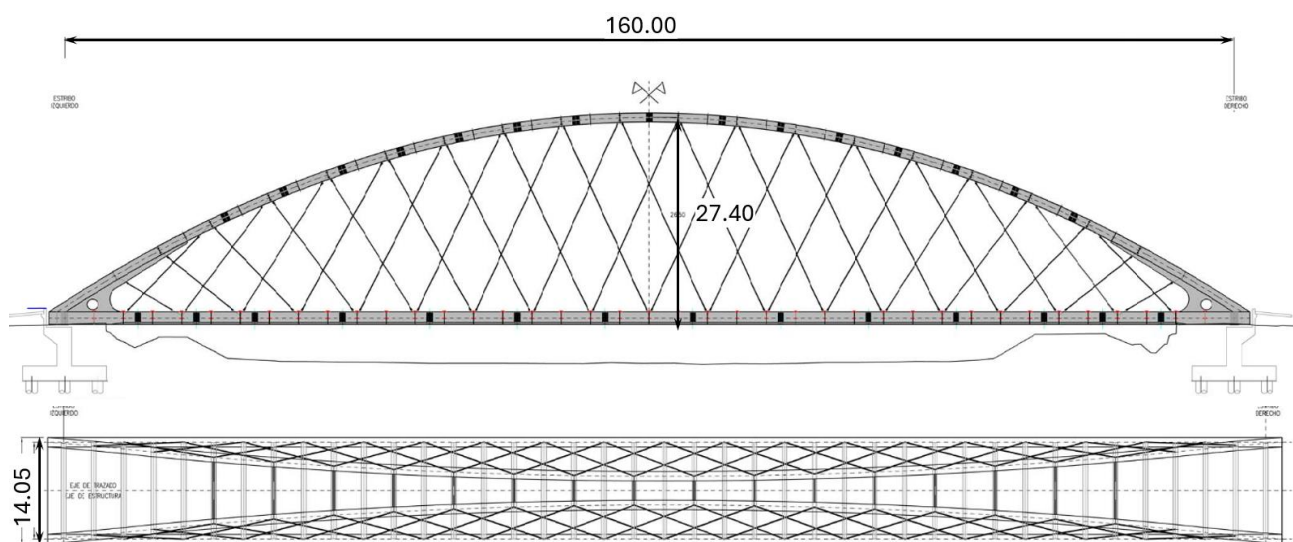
Elevación longitudinal y planta general del Puente Chamorro.
